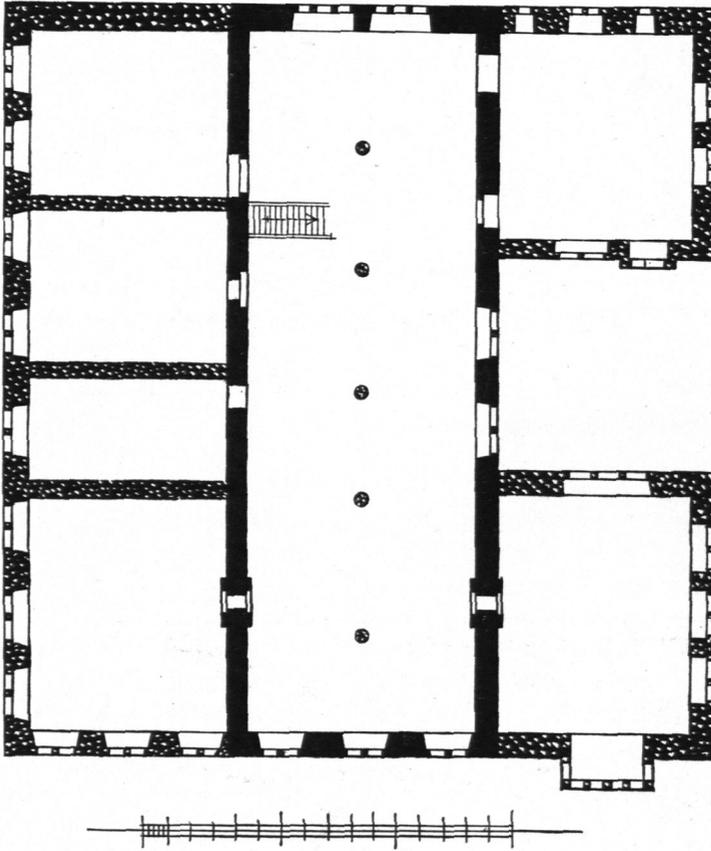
Rathaus zu Münden. Grundriß des oberen Geschosses.
